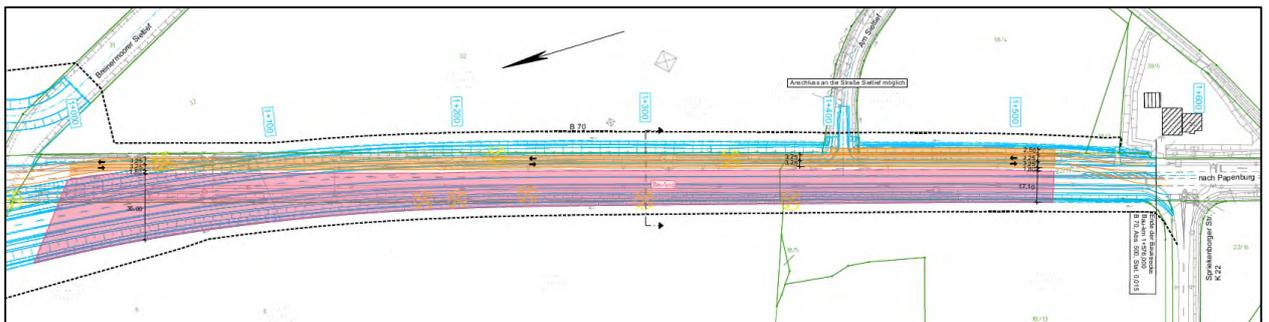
Lageplan Bauphasenplan Süd, Bauphase D2
